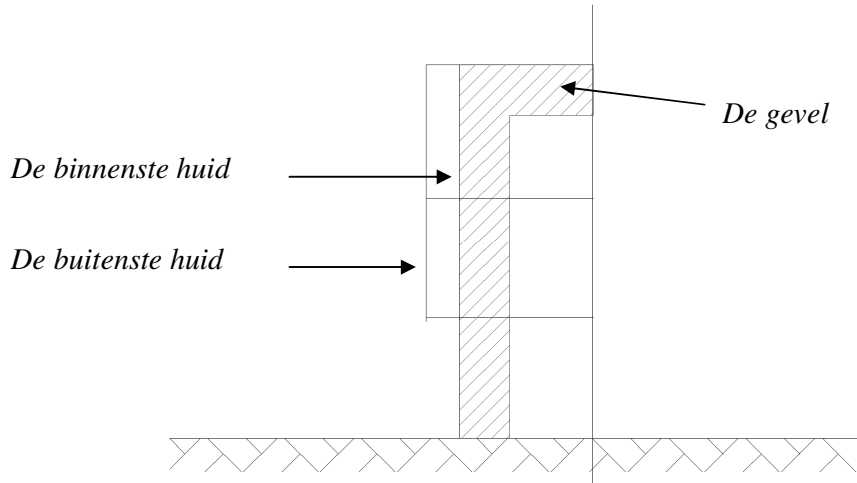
Basisstructuur voor de tweedehuidfaçade
